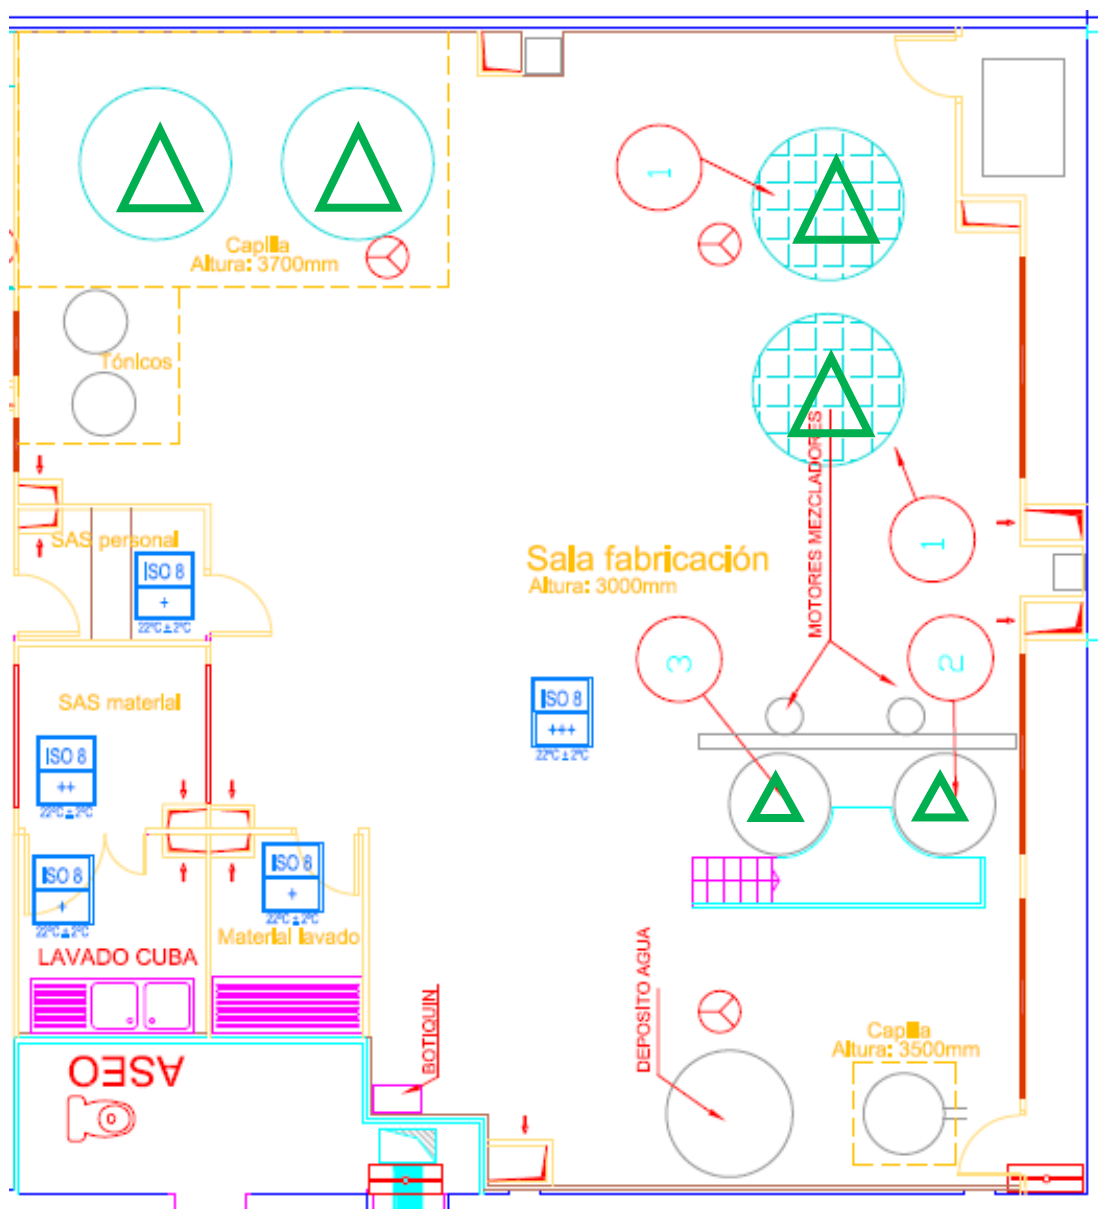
Layout Zona Fabricación (Primera Planta)
